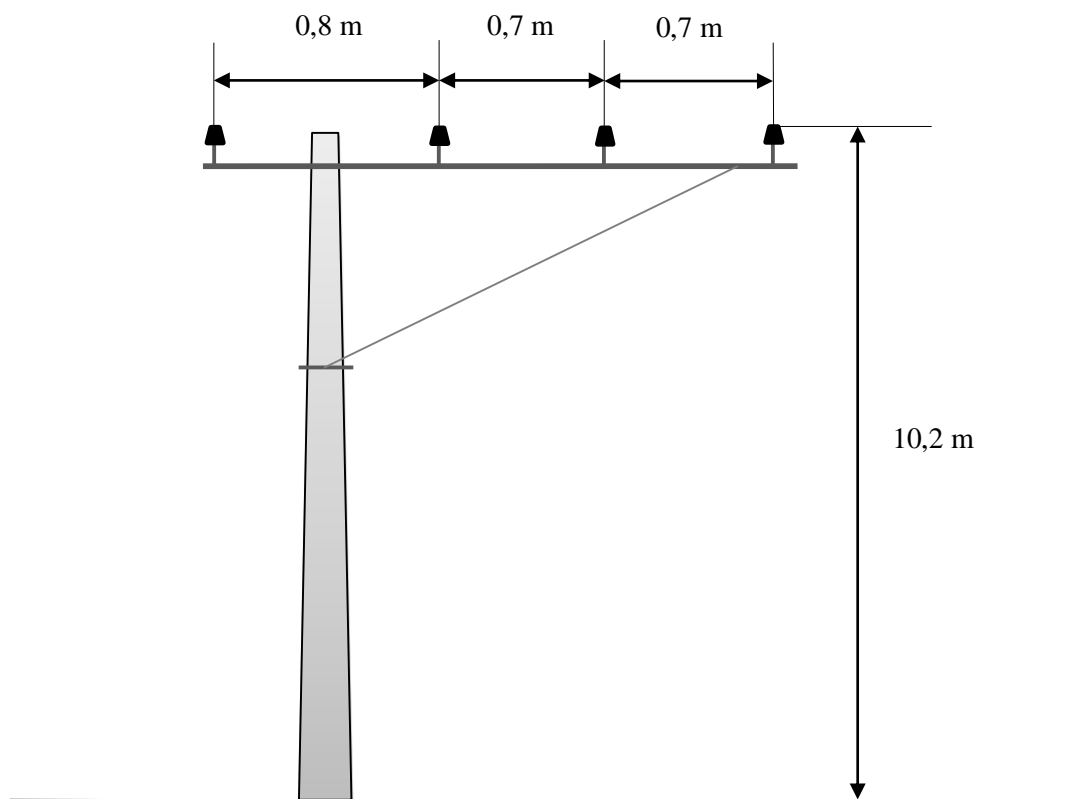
Estructura en bandera con cable de guarda (LD013)
